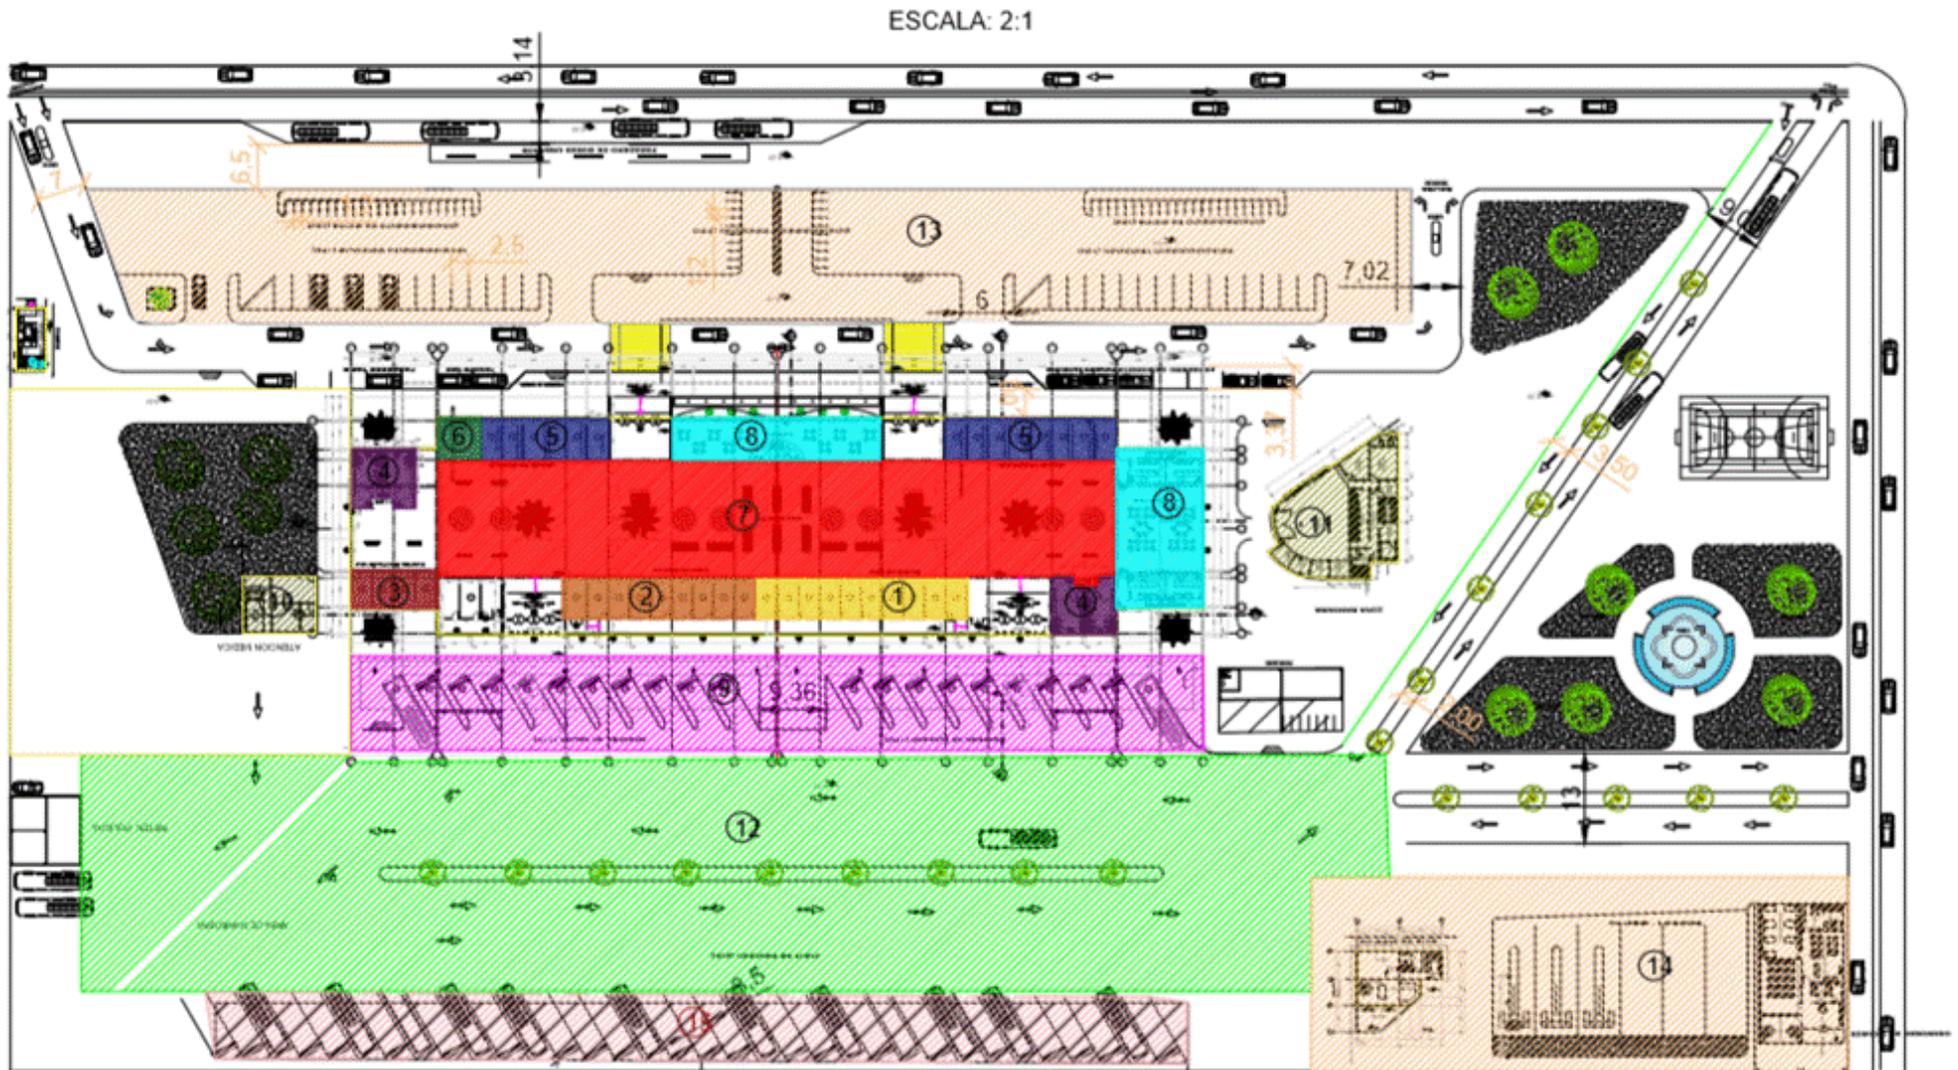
Vista zonificación por áreas del terminal terrestre para la Joya de los Sachas
